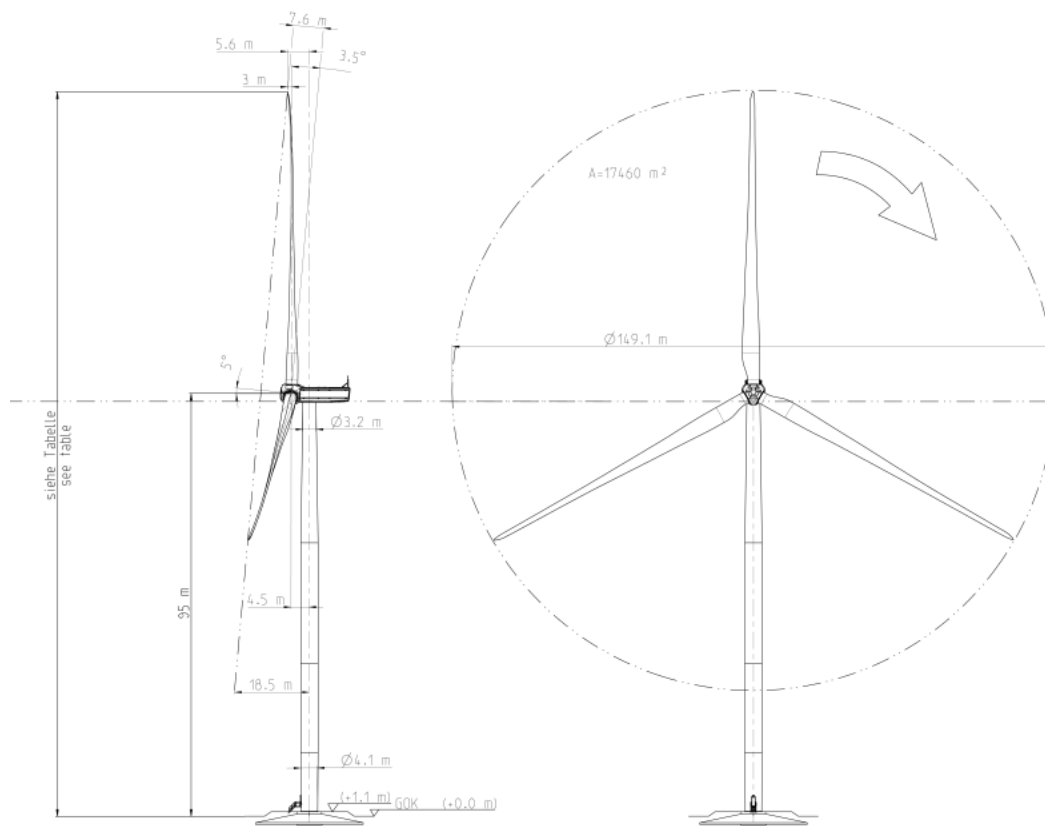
Plan en élévation de l'éolienne NORDEX 149 TS95
